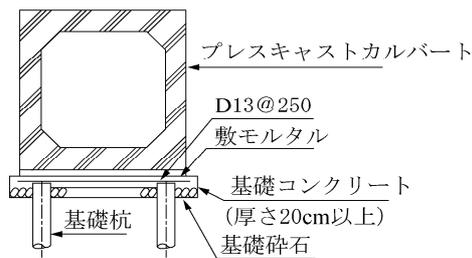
鉄筋コンクリート二次製品暗渠の杭基礎
